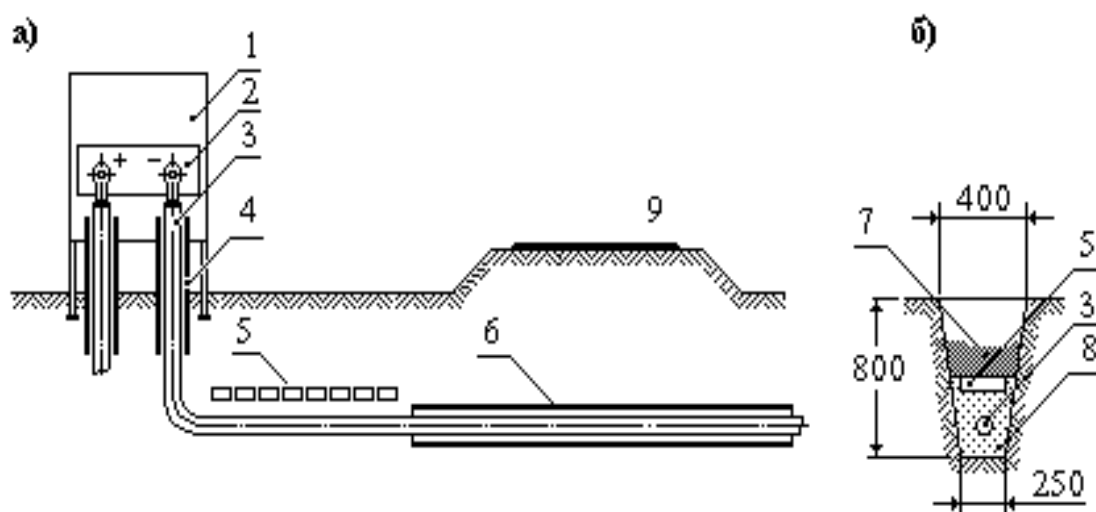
Устройство кабельной дренажной линии катодной станции. 1- преобразователь; 2-клеммник; 3-кабель; 4-стальная труба; 5-красный кирпич; 6-асбестоцементная труба; 7-грунт земляной; 8-песчаная подушка; 9-дорога.
